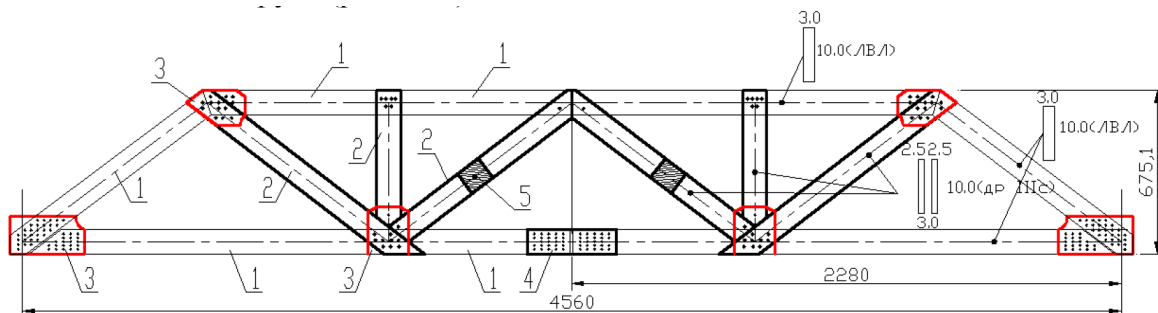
Опытный образец фермы с гвоздевым соединением: 1 – LVL 30×100; 2 – доска 25×100; 3 – фасонки древесно-стружечные (ДСП-В); 4 – накладки из LVL; 5 – прокладки из доски
